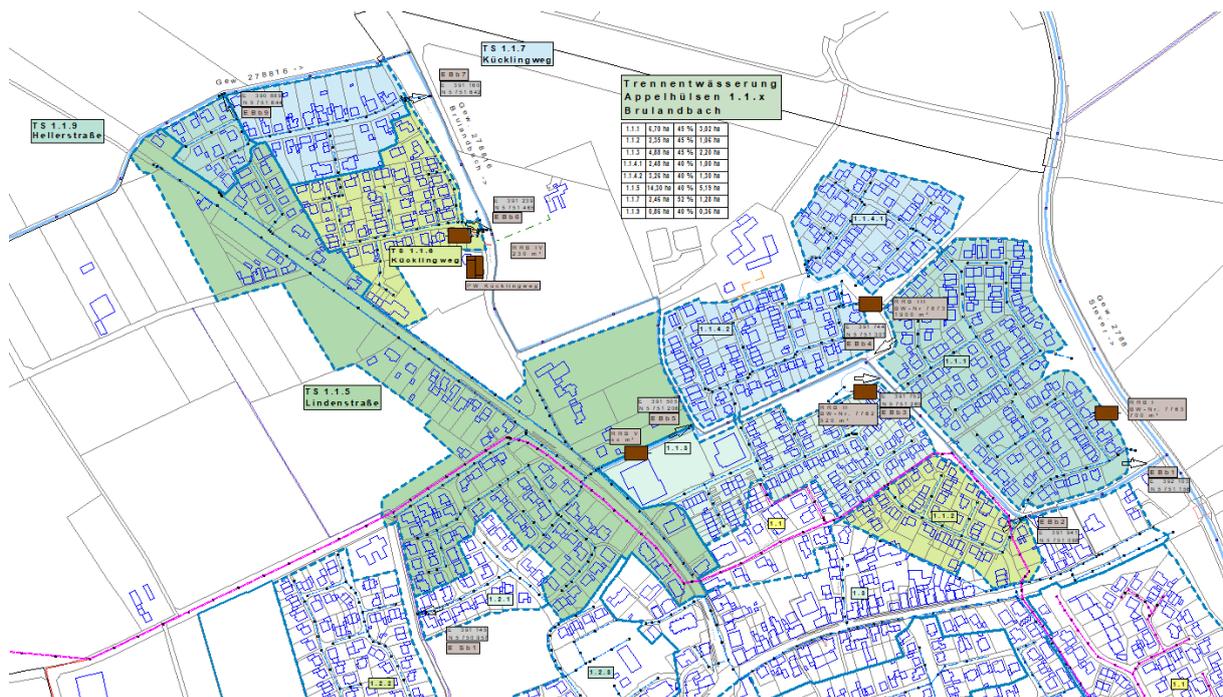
Planausschnitt Appelhülsen Brulandbach
